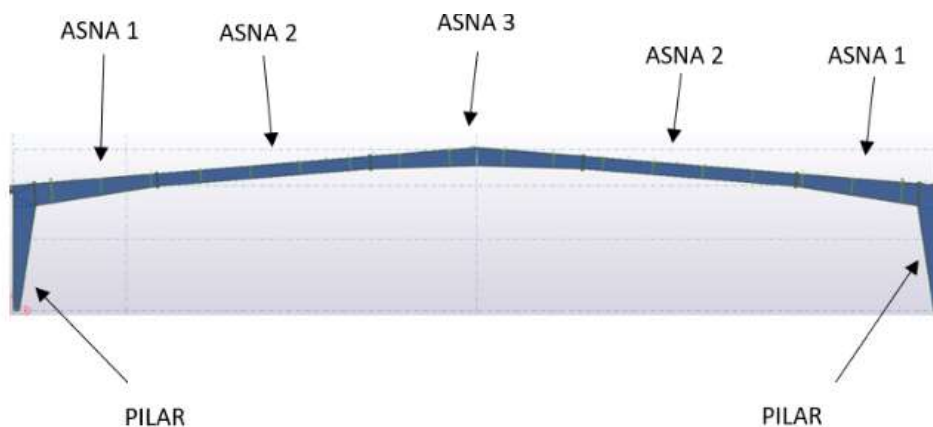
Pórtico do pavilhão de 52 m (elaboração própria)
